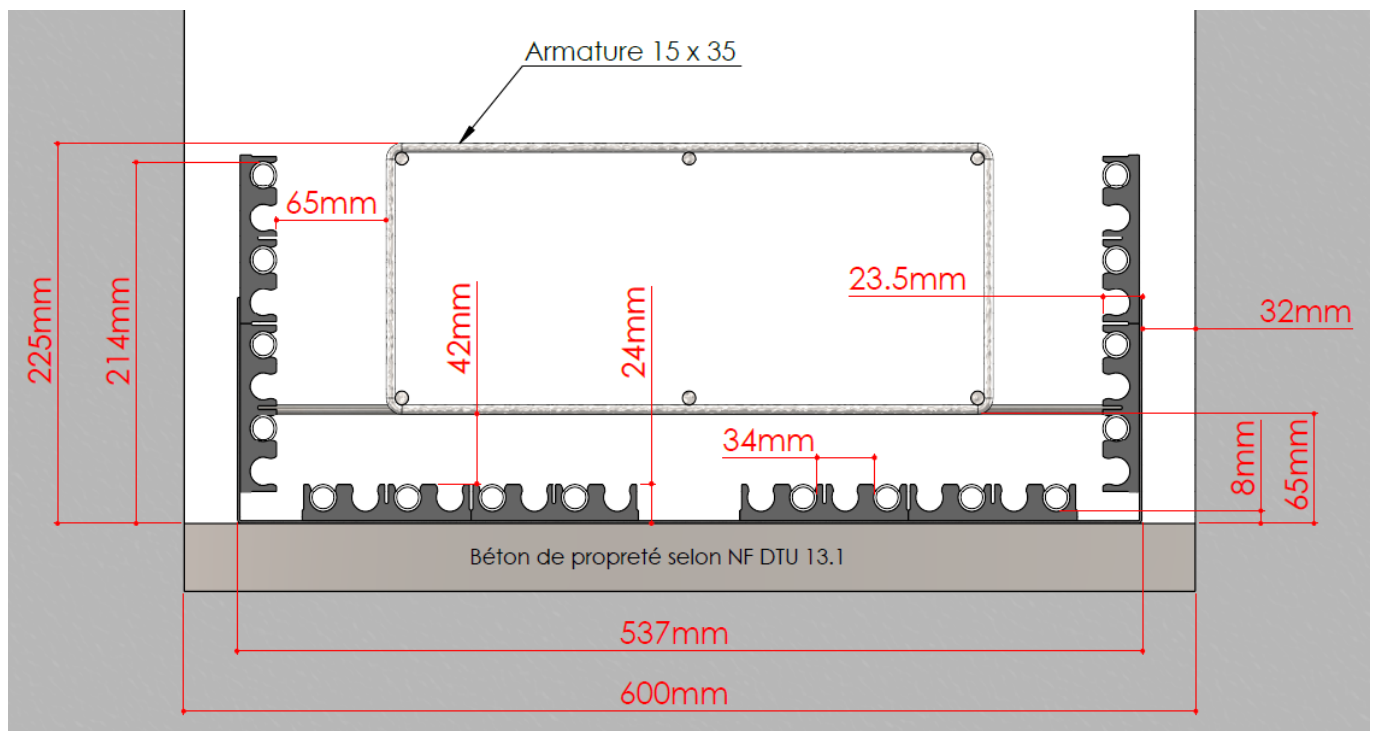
Vue en coupe et en plan d'une semelle type avec berceau, tubes, tige sur-élévatrice et cage d'armatures
